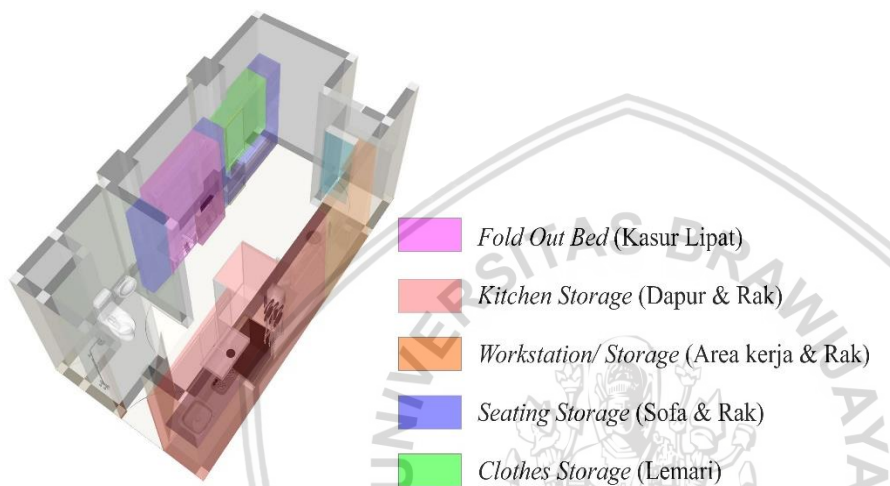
Layout rekomendasi desain Apartemen Puncak Kertajaya
